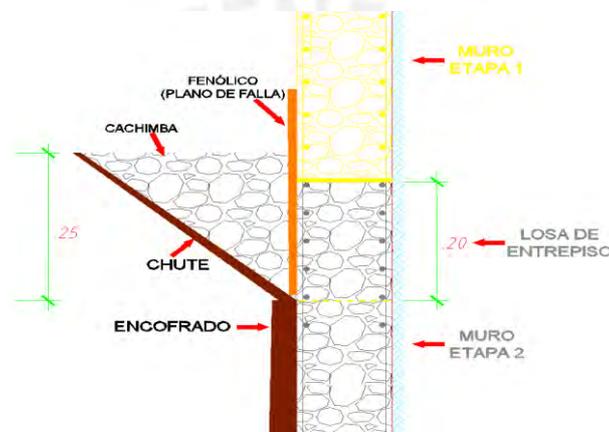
Esquema de cómo se genera el plano de falla con una plancha de madera. (Fuente: RAMOS 2015)
